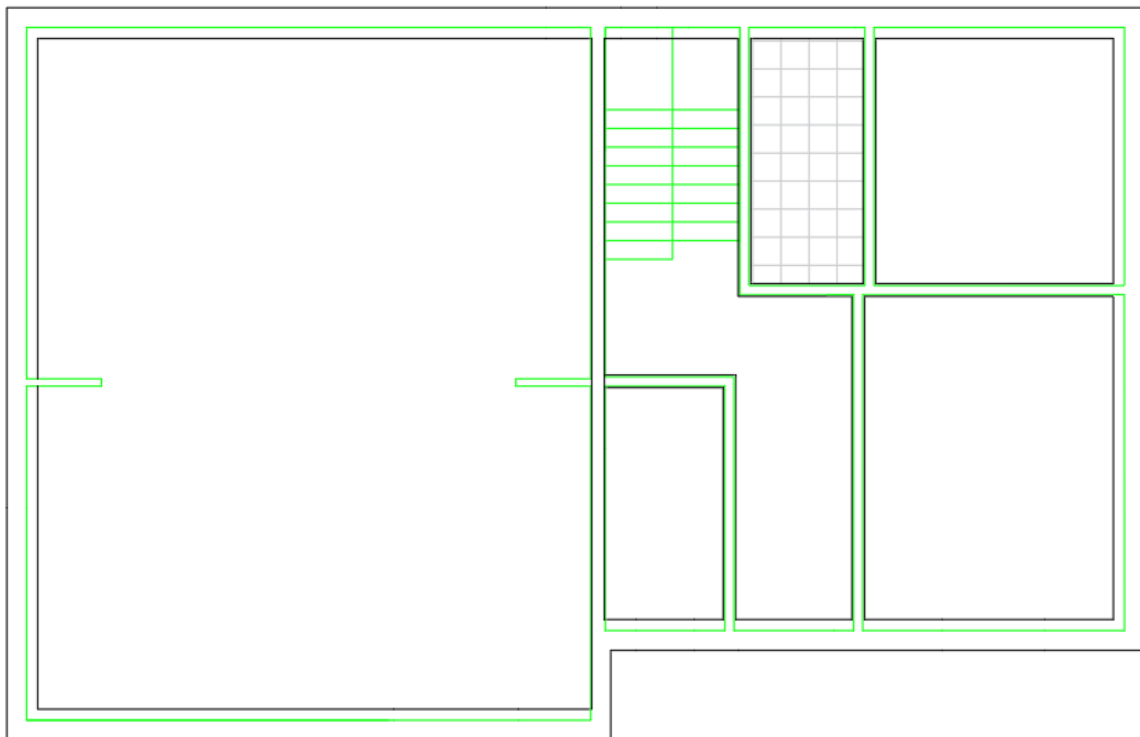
Sobreposição de áreas LSF x Betão Armado
